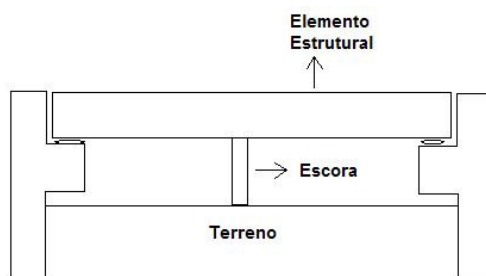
Exemplo simplificado da utilização de escoras em pavimentos.
